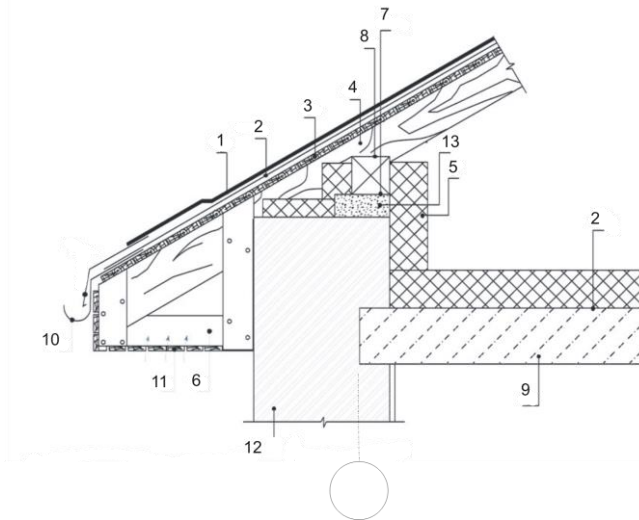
Конструкция карнизного свеса: 1 – кровельное покрытие из гибкой черепицы; 2 – пароизоляционная мембрана; 3 – обрешетка; 4 – стропильная нога; 5 – теплоизоляционный материал; 6 – каркас карниза; 7 – подкладочный слой рубероида; 8 – мауэрлат; 9 – перекрытие; 10 – крепление водосточного желоба; 11 – подшивка карниза; 12 – стеновая панель; 13 – цементно-песчаная армированная стяжка
